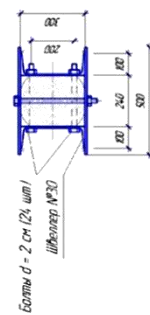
Рекомендуемое усиление поврежденной несущей деревянной балки чердачного перекрытия
